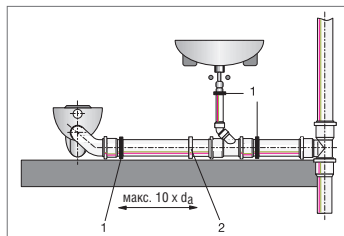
Схема монтажа горизонтального трубопровода
